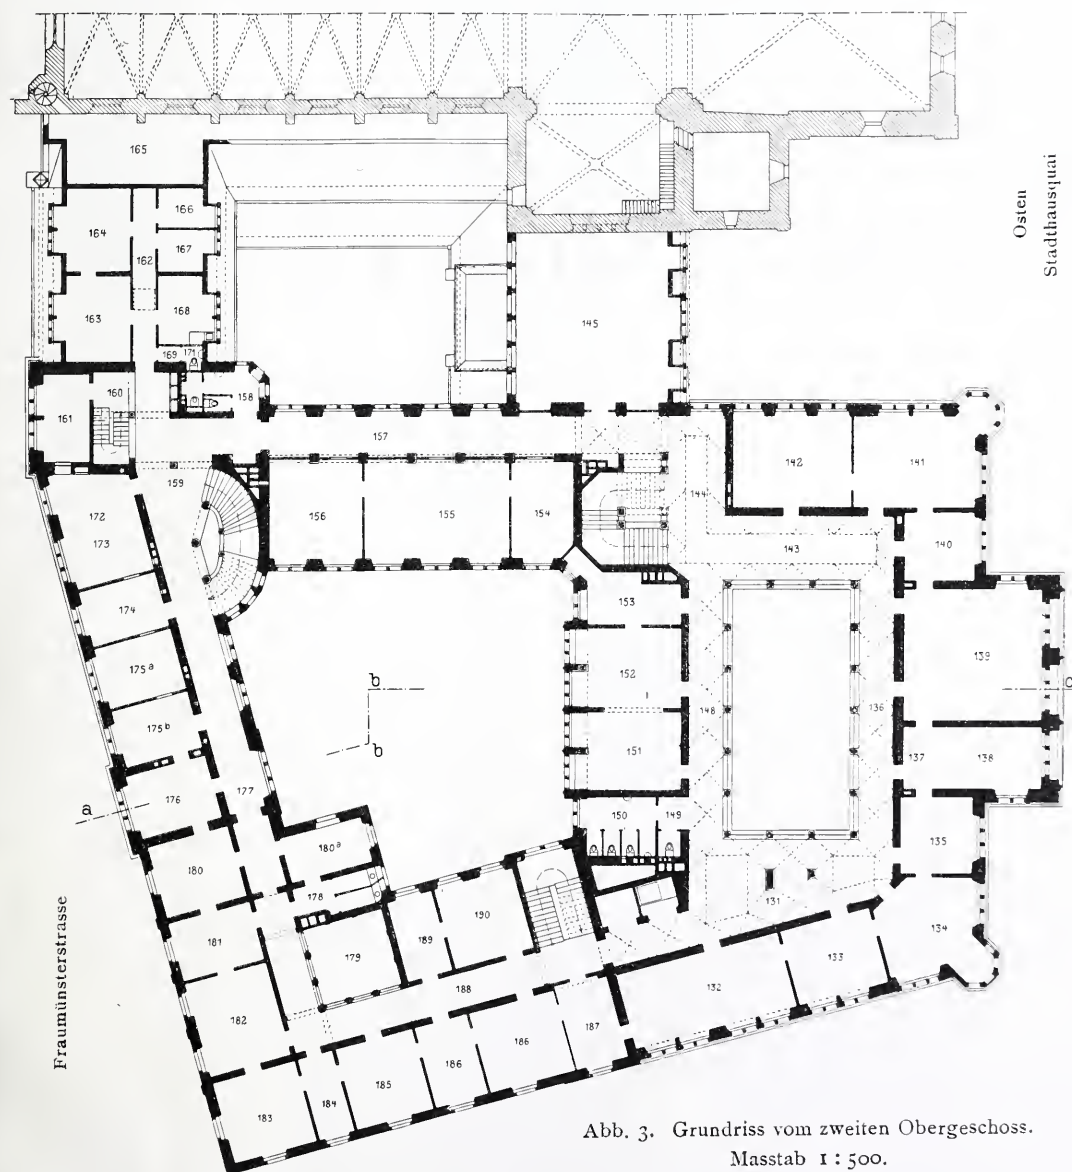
Grundriss vom zweiten Obergeschoss.
